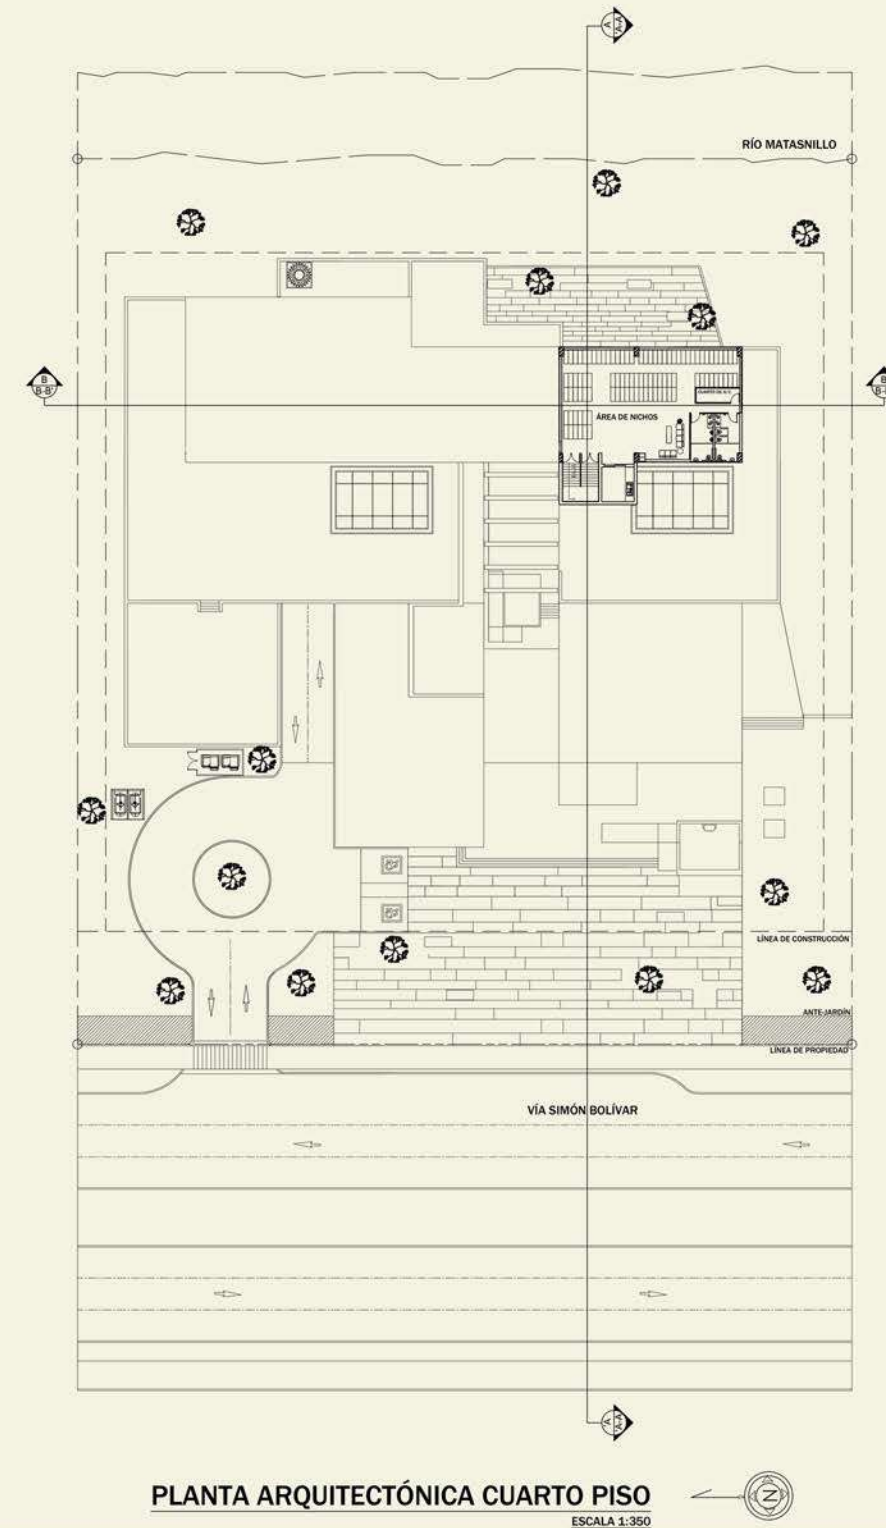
Planta arquitectónica cuarto piso. (Escala para plano 2x3)
